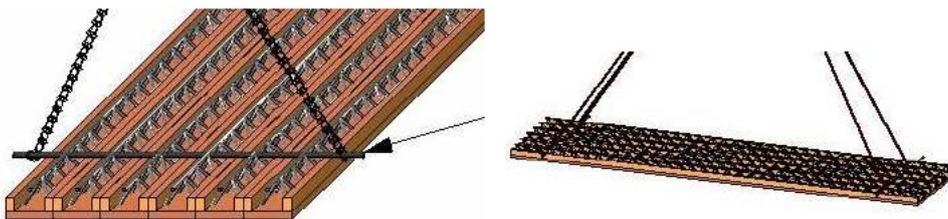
sollevamento di più travetti tralicciati contemporaneamente
